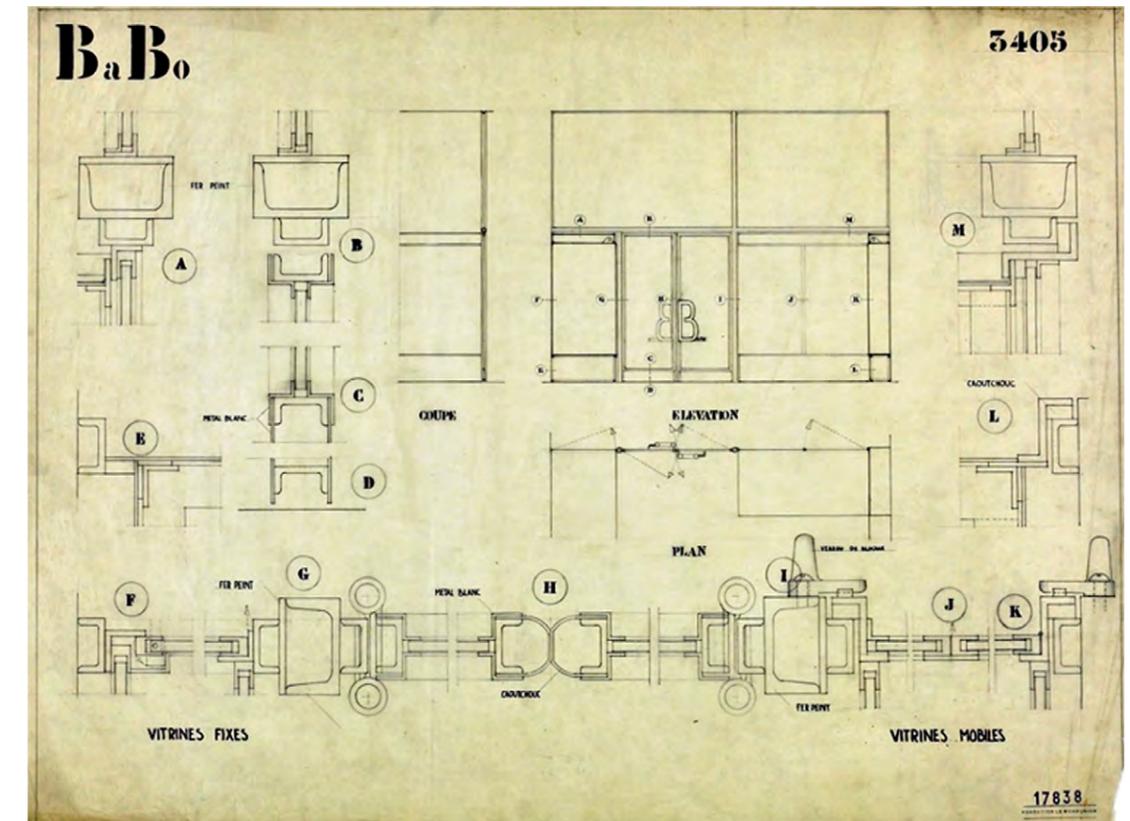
FLC 17838/Ba Bo: Plano de alzado interior y detalles de uniones.
